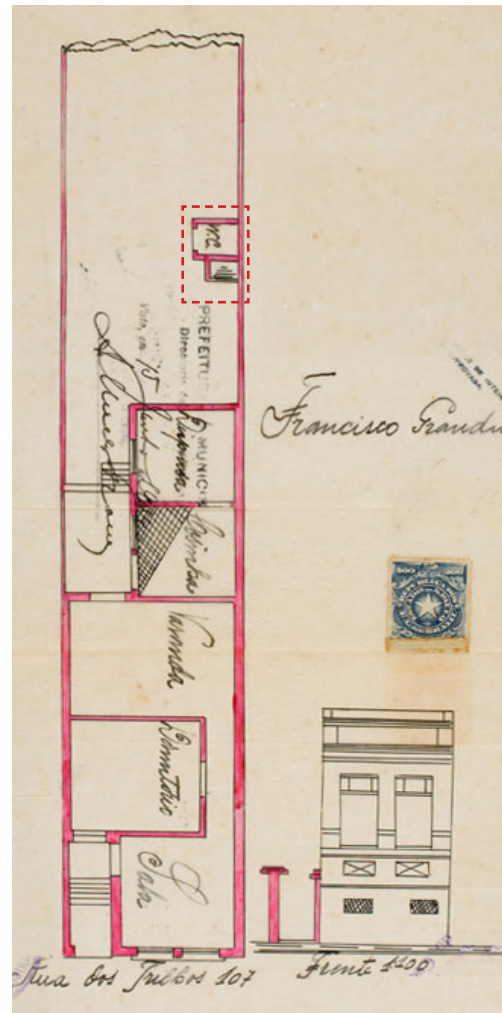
e 3.15 Plantas com cômodo sanitário tipo “A”.
